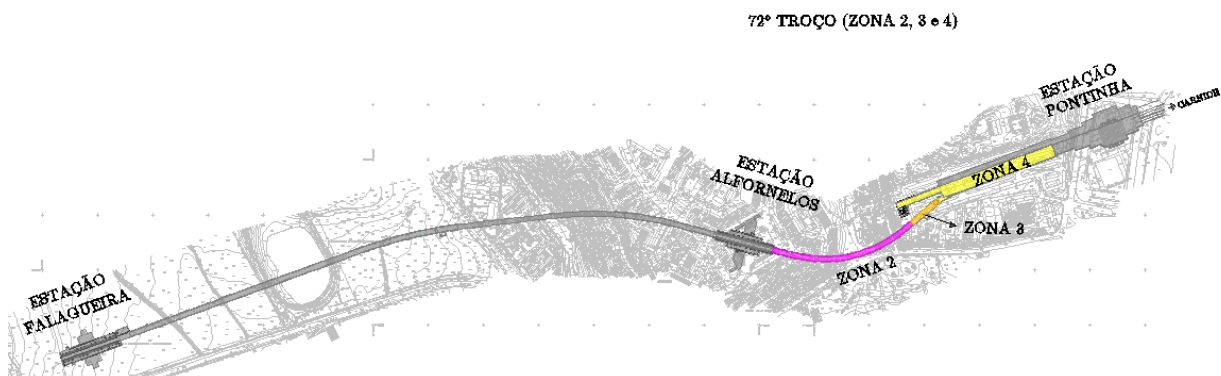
Planta do troço 72 (zona 2, 3 e 4).
